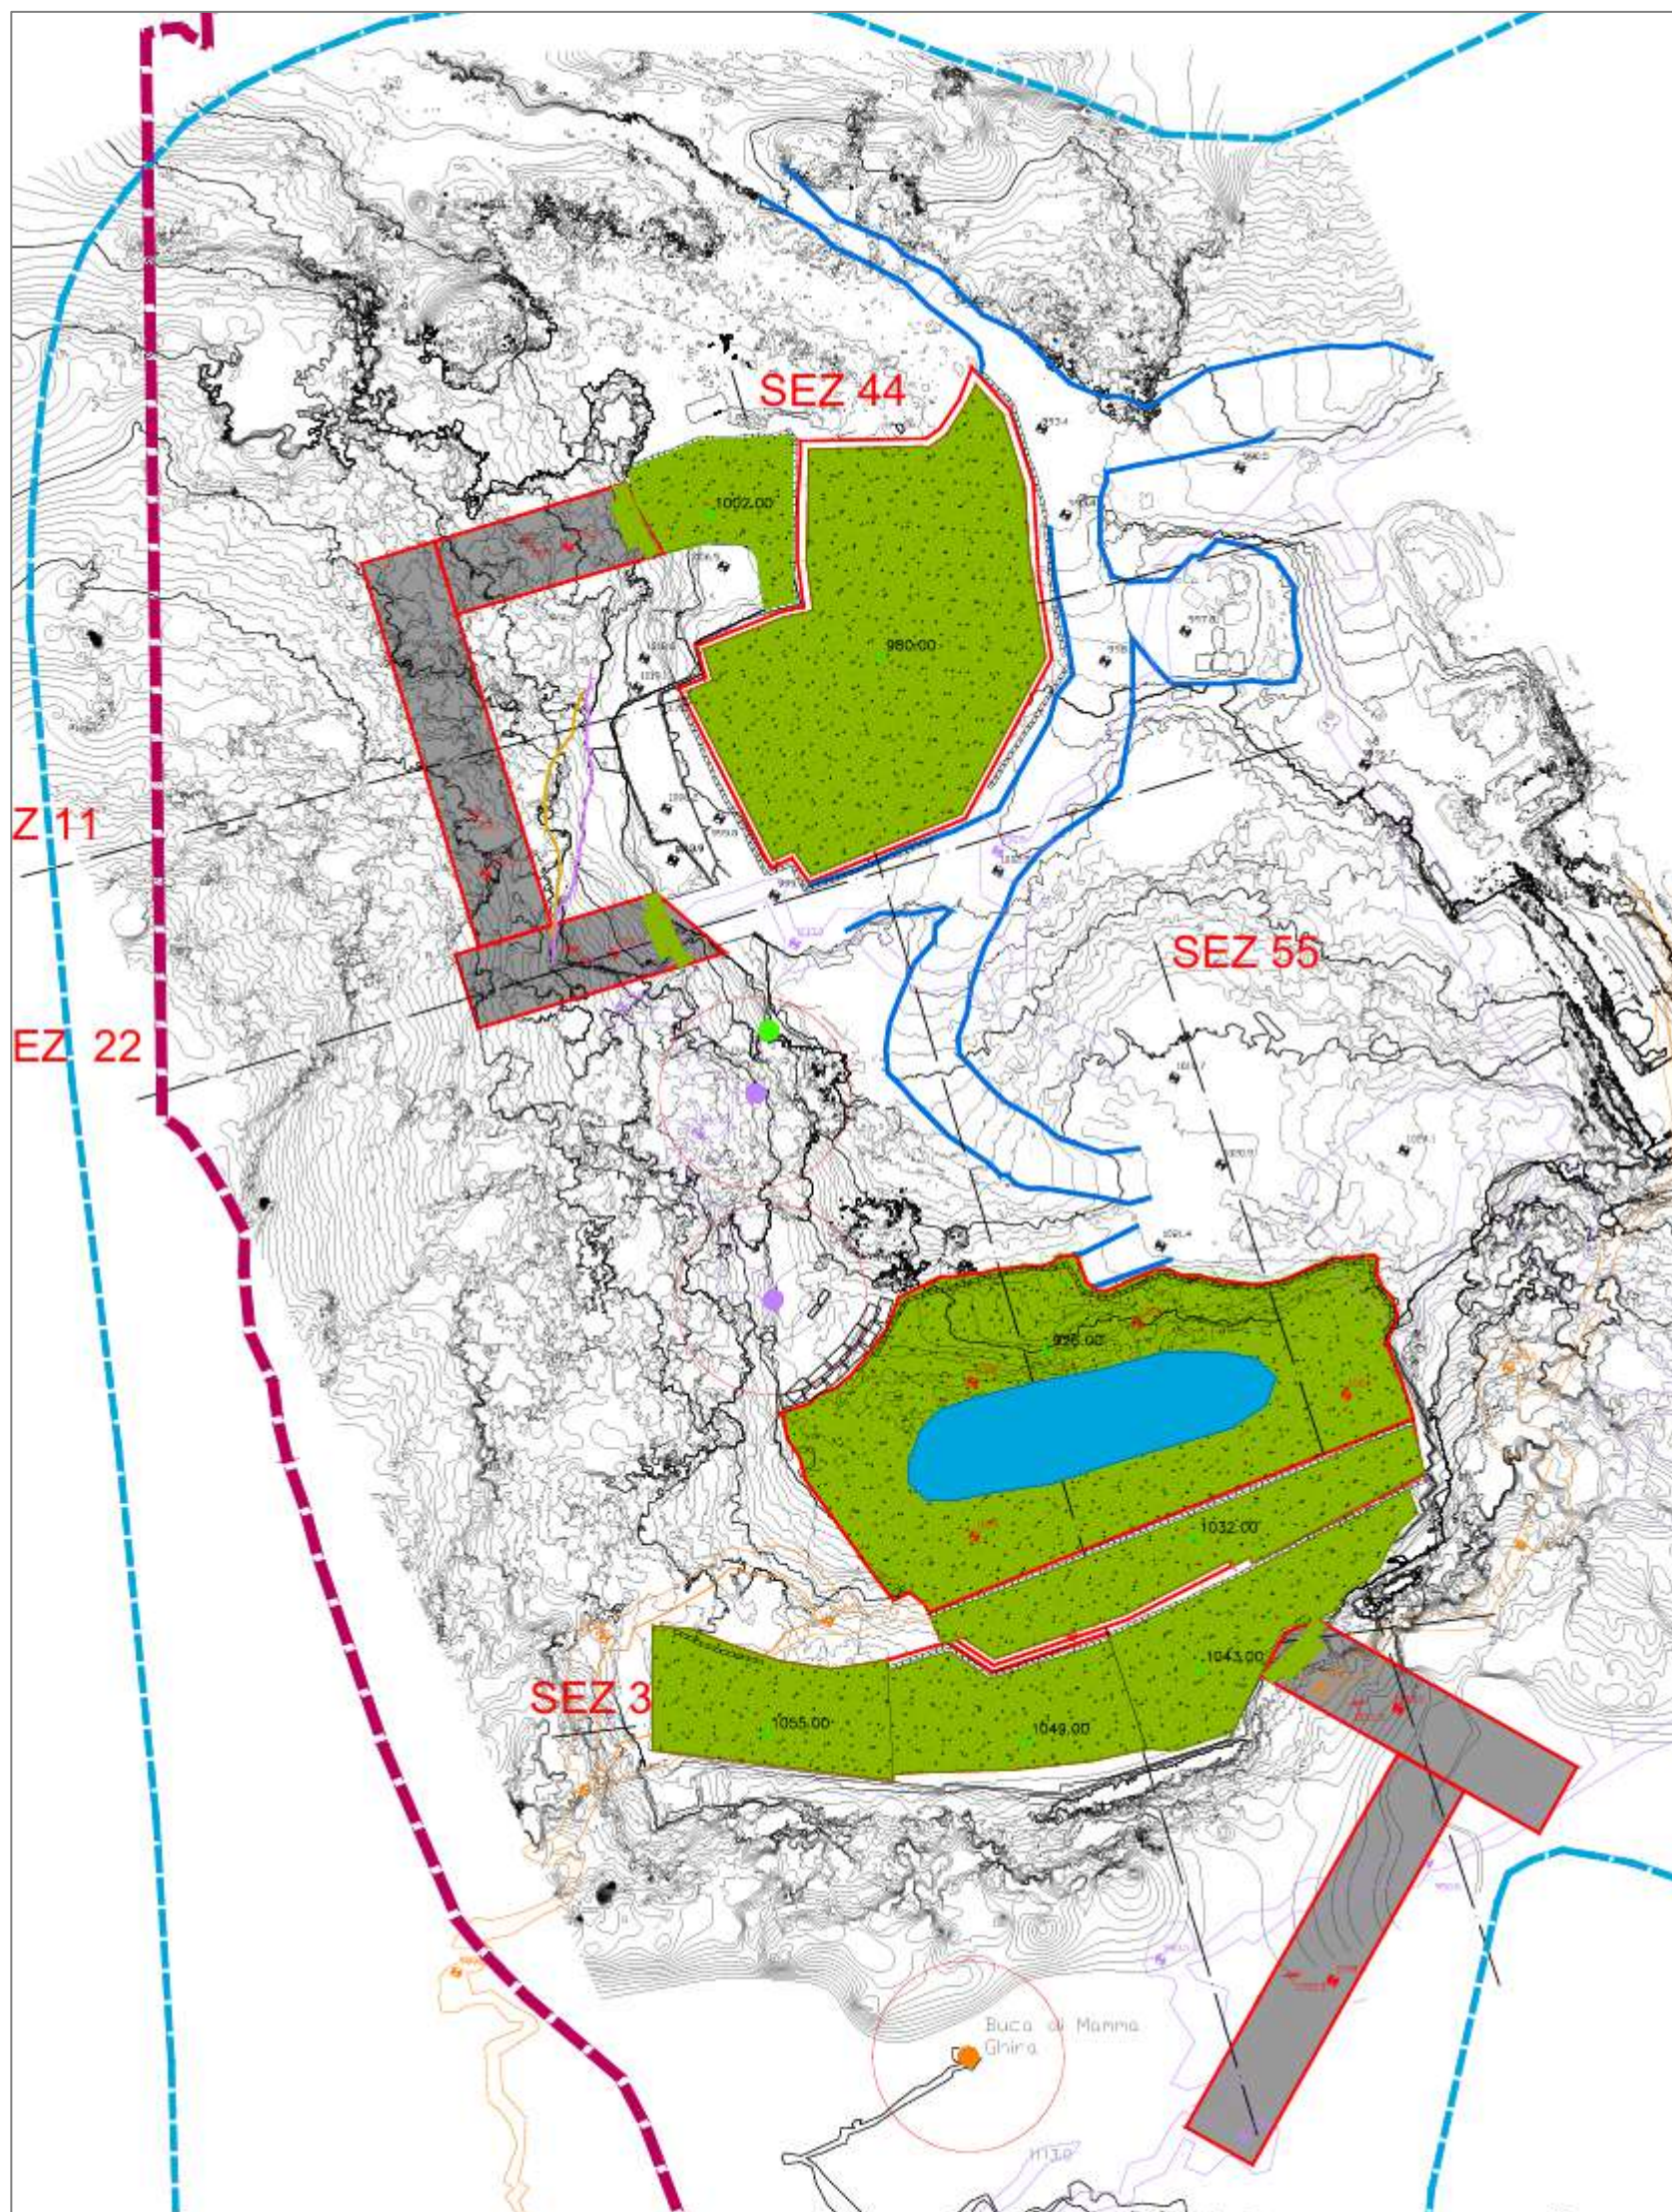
Planimetria risistemazione e reinserimento ambientale (Tav. 11.1).
